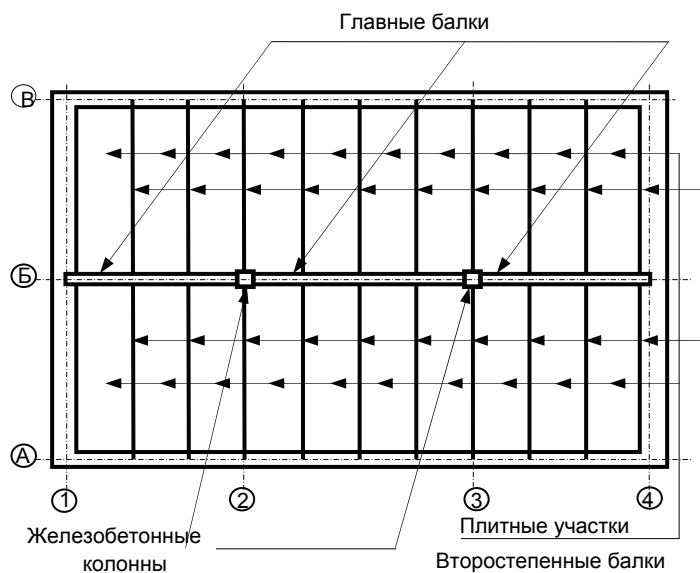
Схема раскладки элементов железобетонного монолитного перекрытия
